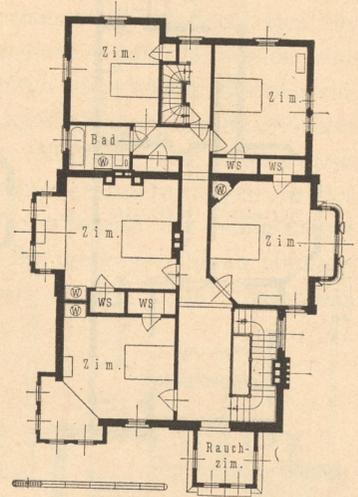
u. 254<sup>236</sup>) zeigen den Grundriss vom Erdgeschoss und Obergeschoss eines Wohnhauses zu New-Haven (Arch.:
